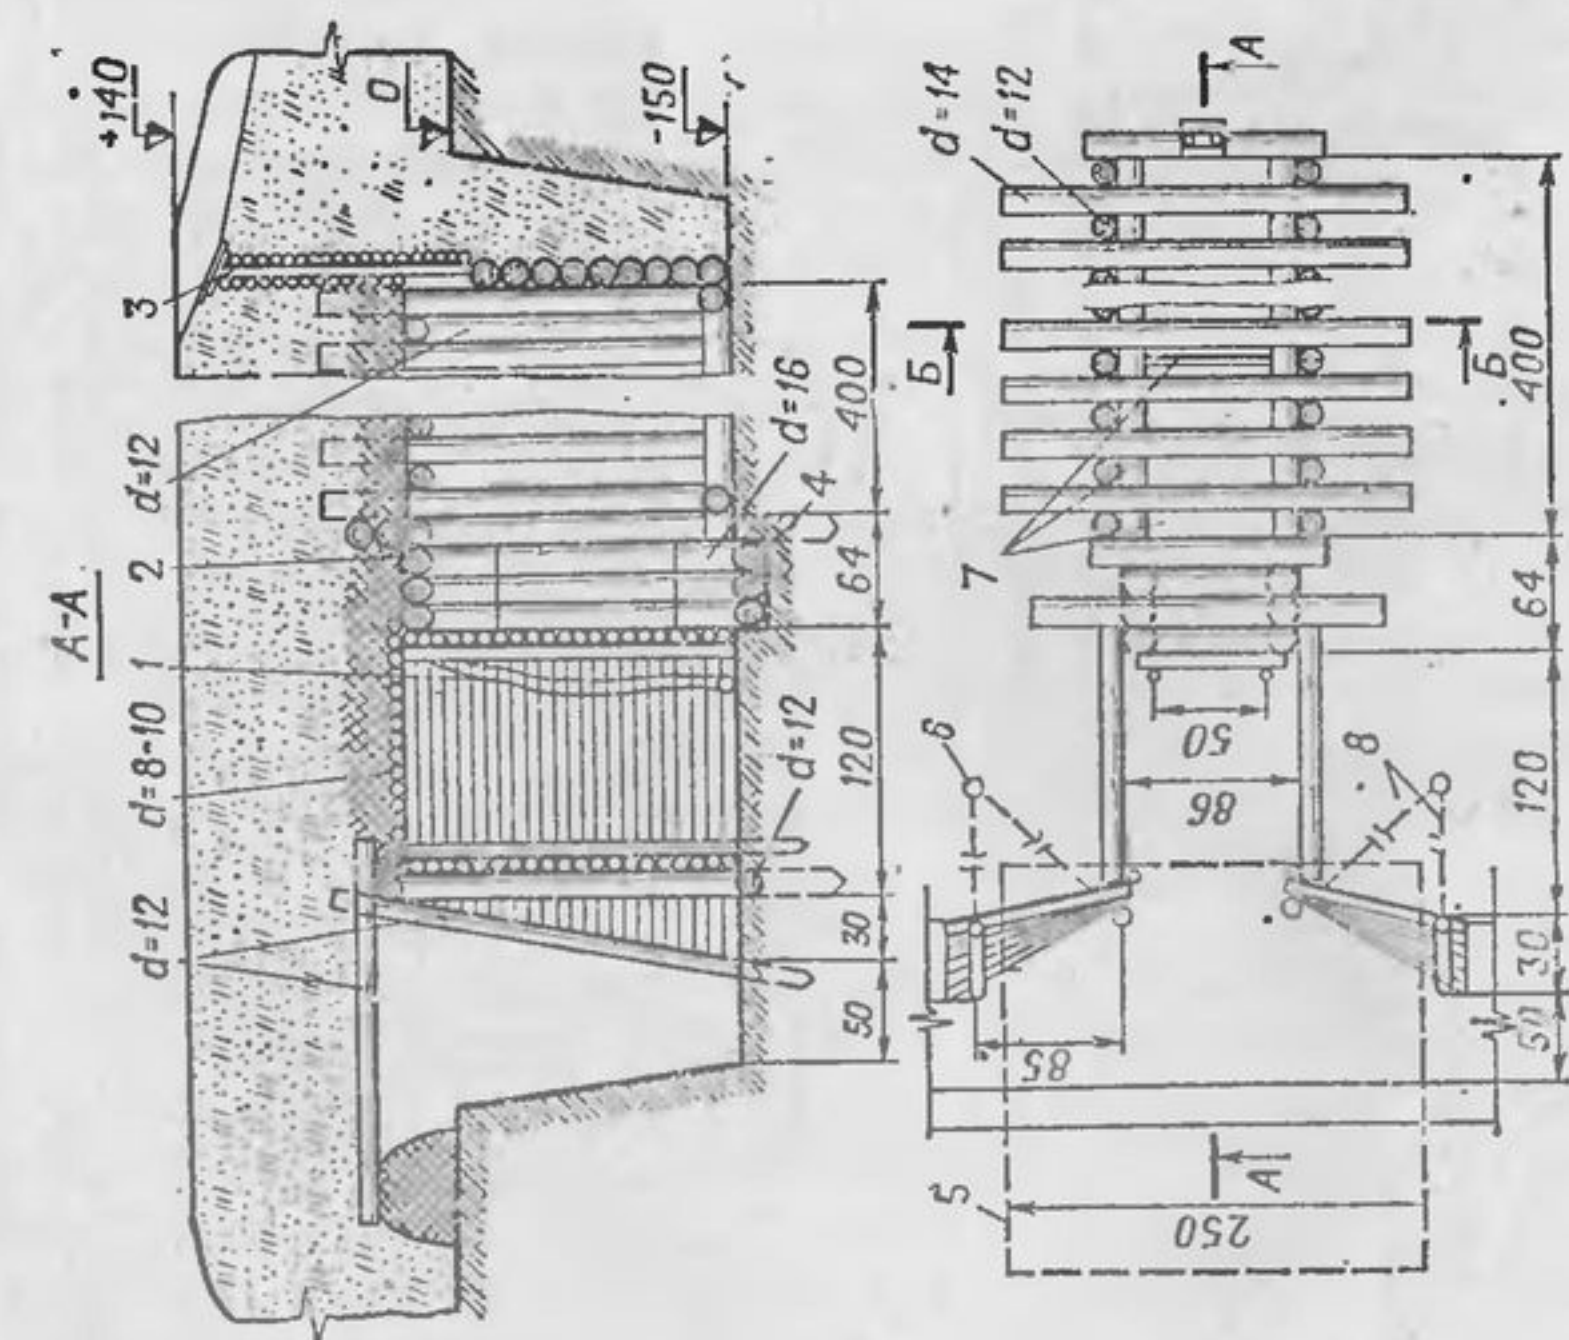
Блиндаж податливой конструкции прямоугольного типа из круглого леса:
